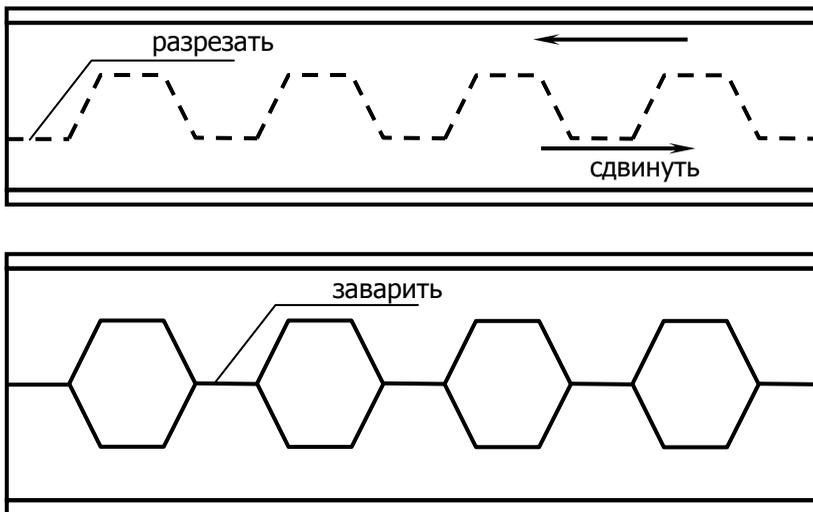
Увеличение высоты балки без увеличения ее металлоемкости; а – схема разрезки двутавровой прокатной балки, б – схема сварки.
